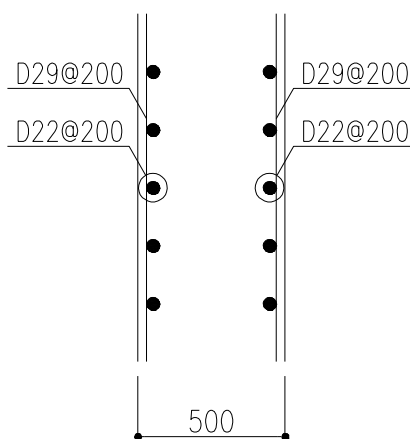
耐震壁の配筋図 (3階9通り B~C通り間)
